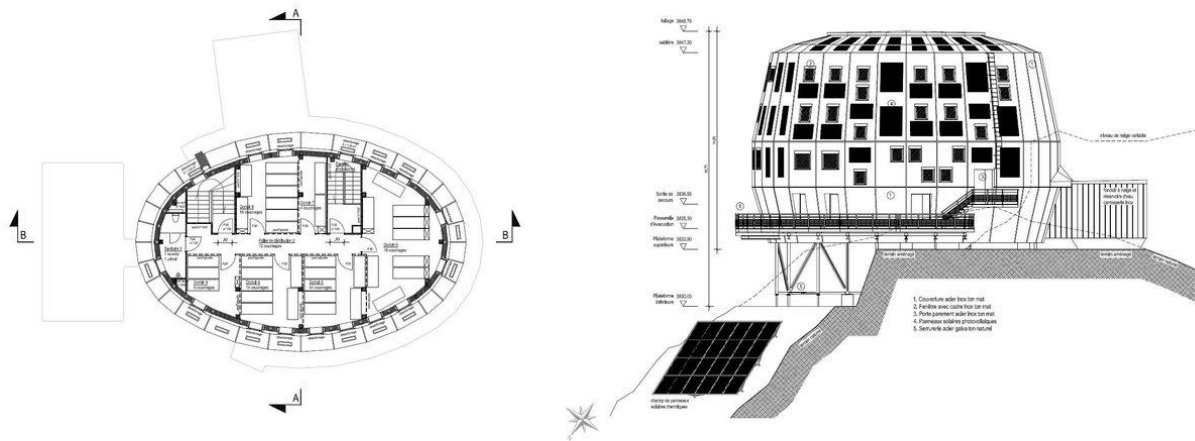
Plan R+3, dortoirs et infirmerie et élévation Sud-Ouest
